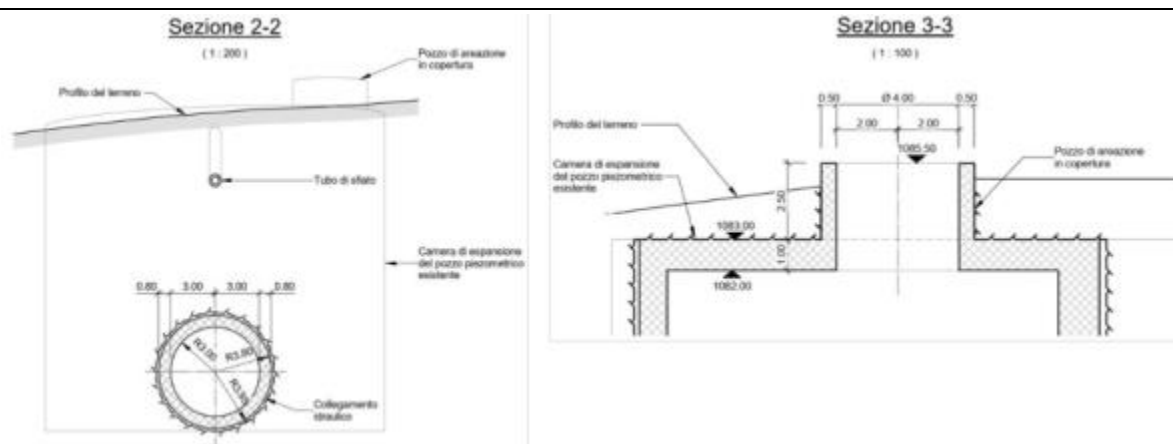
Nuova camera di espansione al pozzo piezometrico sulla derivazione Provvidenza – sezione collegamento idraulico alla nuova camera e pozzo di aerazione in copertura
